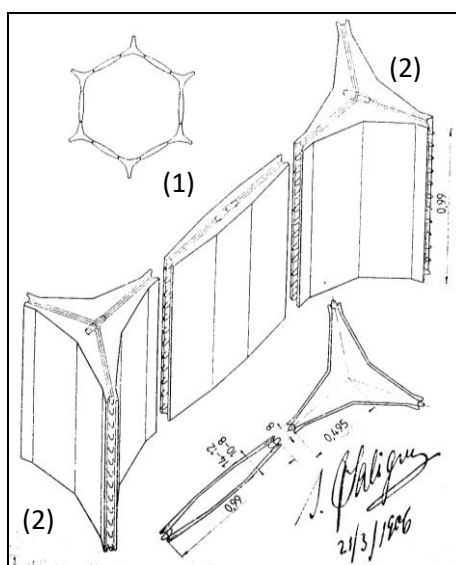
Tipurile de elemente prefabricate din beton armat folosite la execuția celulelor silozurilor de cereale de la Constanța, proiectant inginer Anghel Saligny, 1906. Sursa [1].
